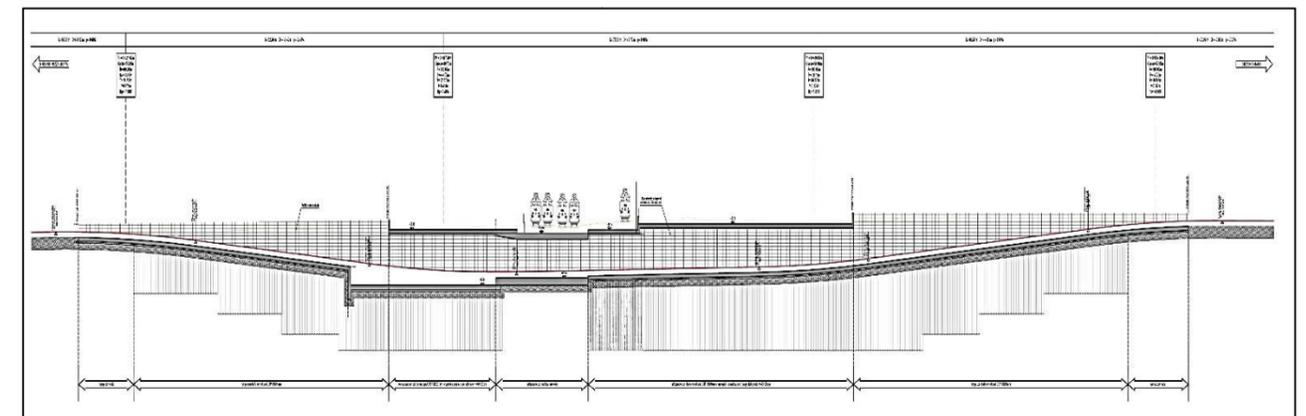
Sezione longitudinale sottoattraversamento-sottopasso
